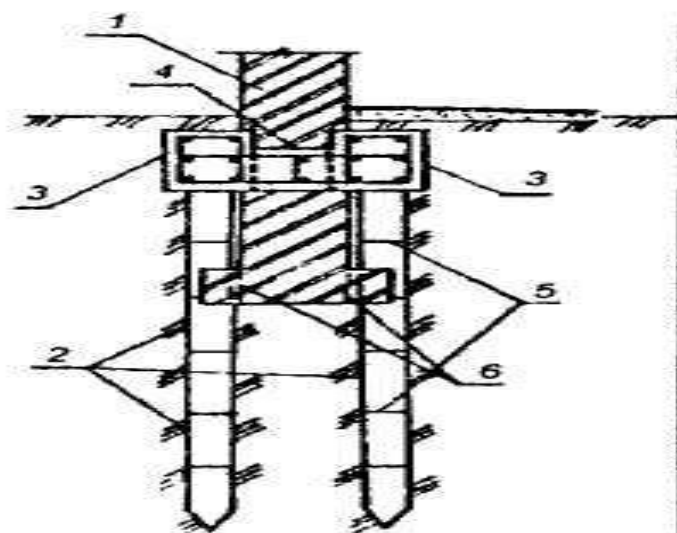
Передача нагрузки от стены на составные железобетонные сваи, погружаемые вдавливанием
